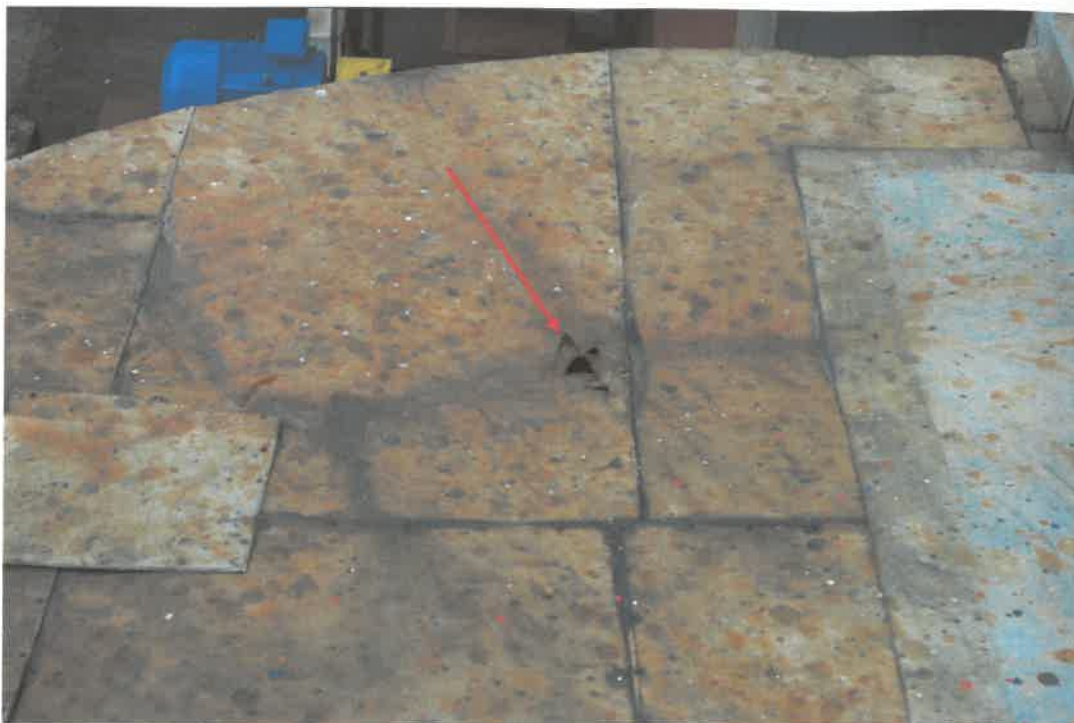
Poziom +14 m, strona wschodnia. Nieszczelność na styku dachu czopucha z żelbetowym trzonem komina
